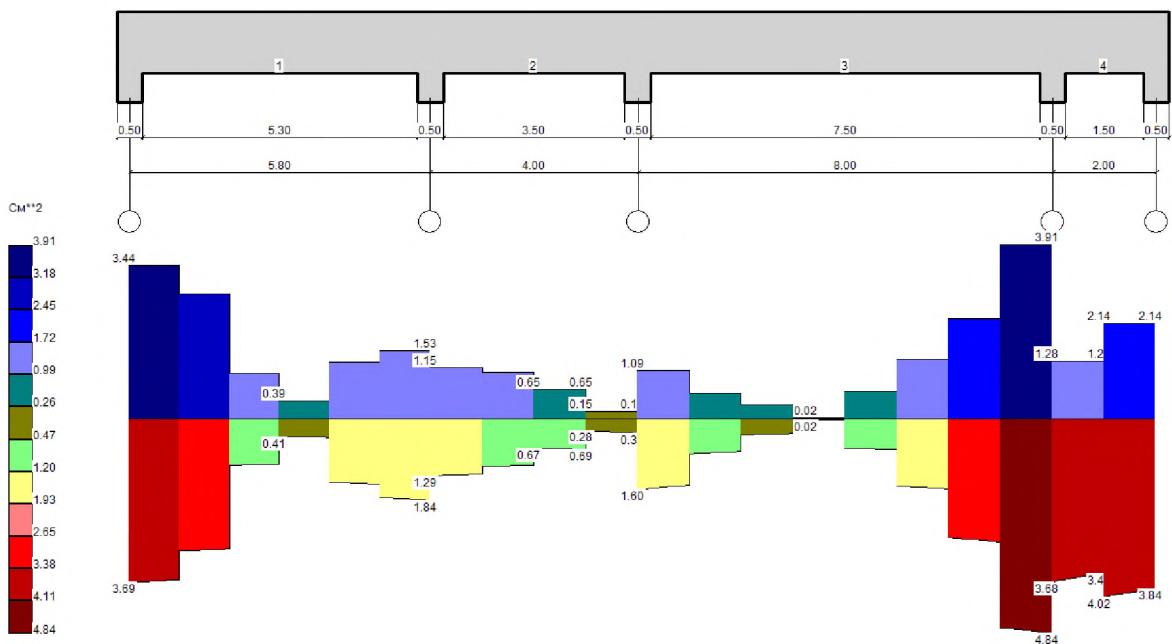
Балка № 7. Епюра поперечного армування
